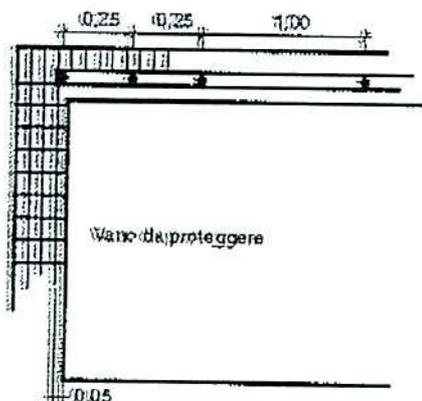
Condizione di fissaggio rete fissata sotto listelli, senza listello di testa nella parte terminale del vano
